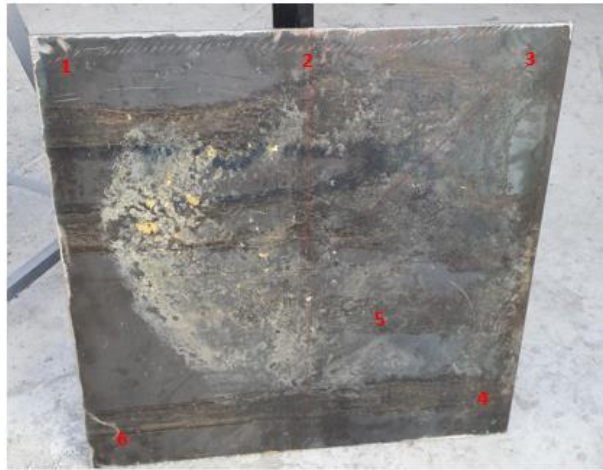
Fisuración en el recebo durante el ensayo de platina 3/8
